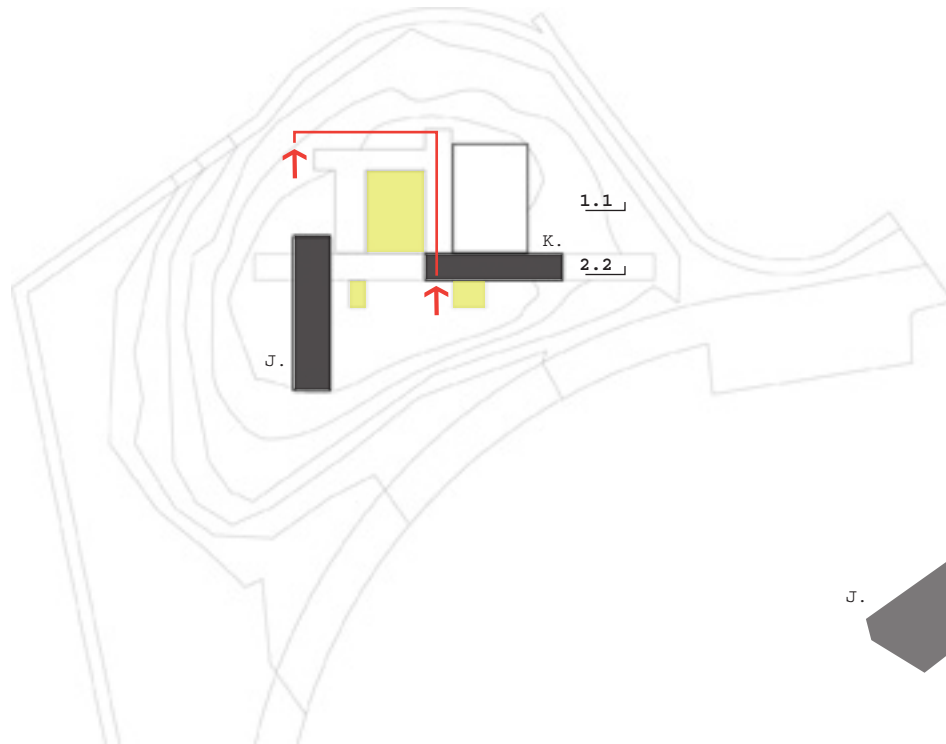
Zonificación en planta nivel +0.0m / Fuente : propia
